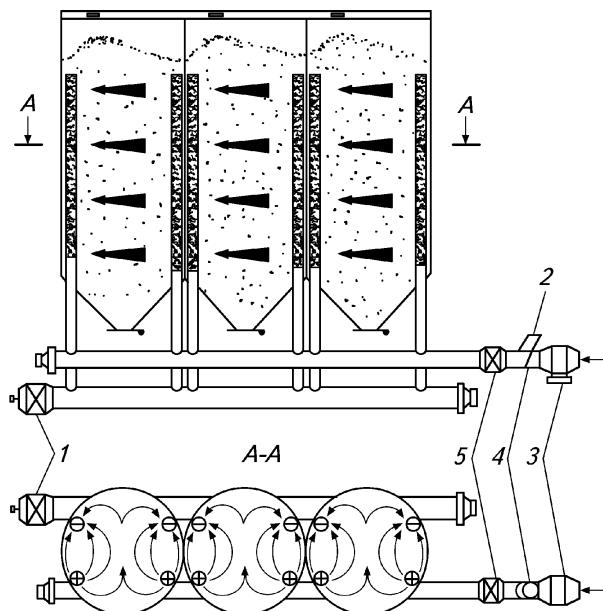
Схема напорно-вытяжной установки для вентилирования зерна поперек силоса с применением перфорированных трубопроводов:
